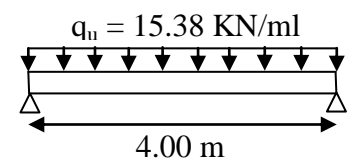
Schéma statique de la poutre de chaînage 2
